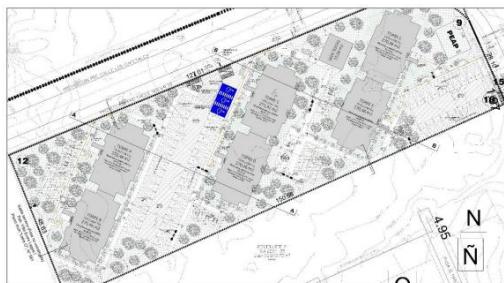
Plano planta – Lote D. Villa Unidos por Nuestra Casa
